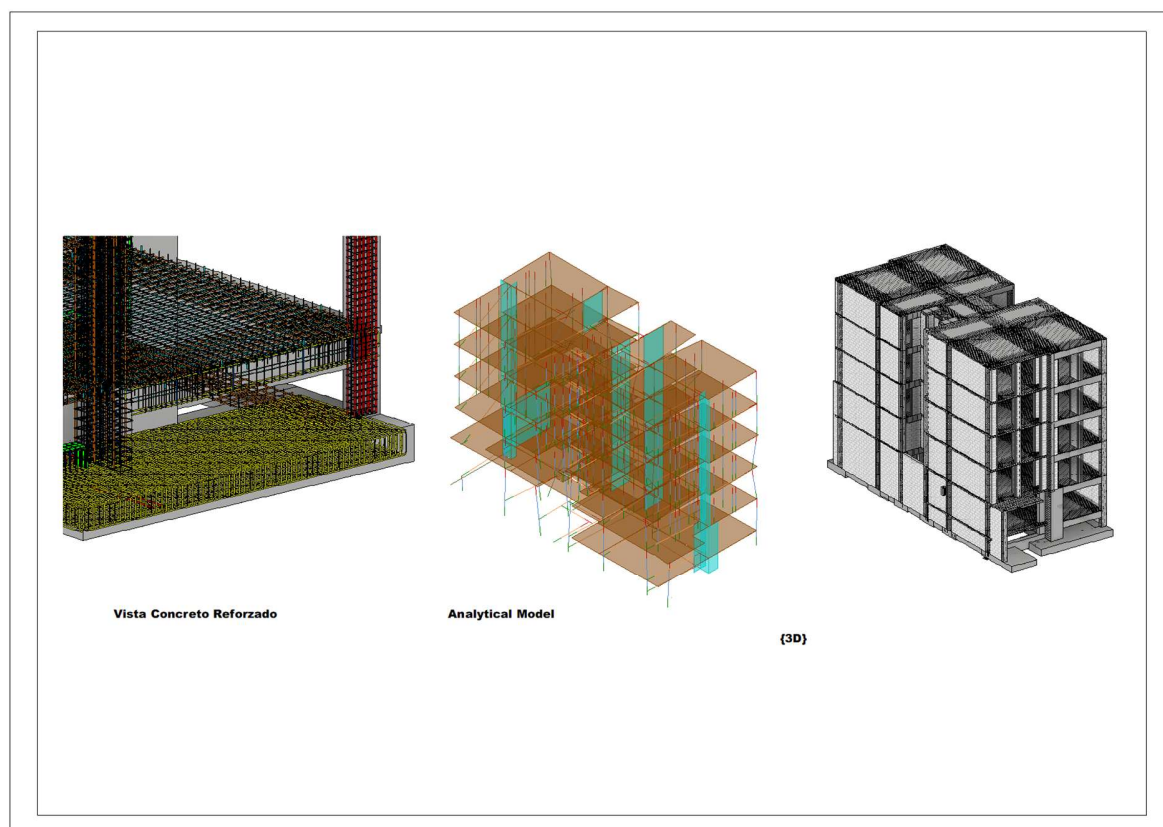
Vista del modelo de concreto reforzado, analítico y arquitectónico
